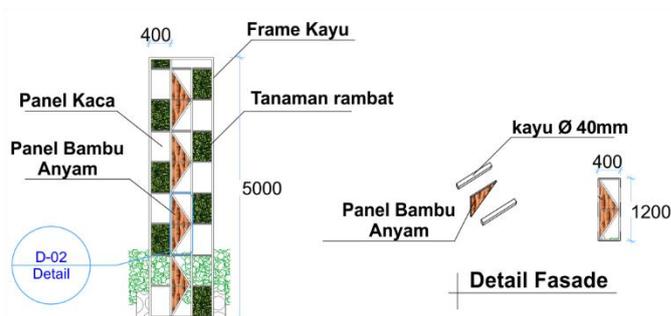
Penerapan bambu untuk penyekat ruang lounge
